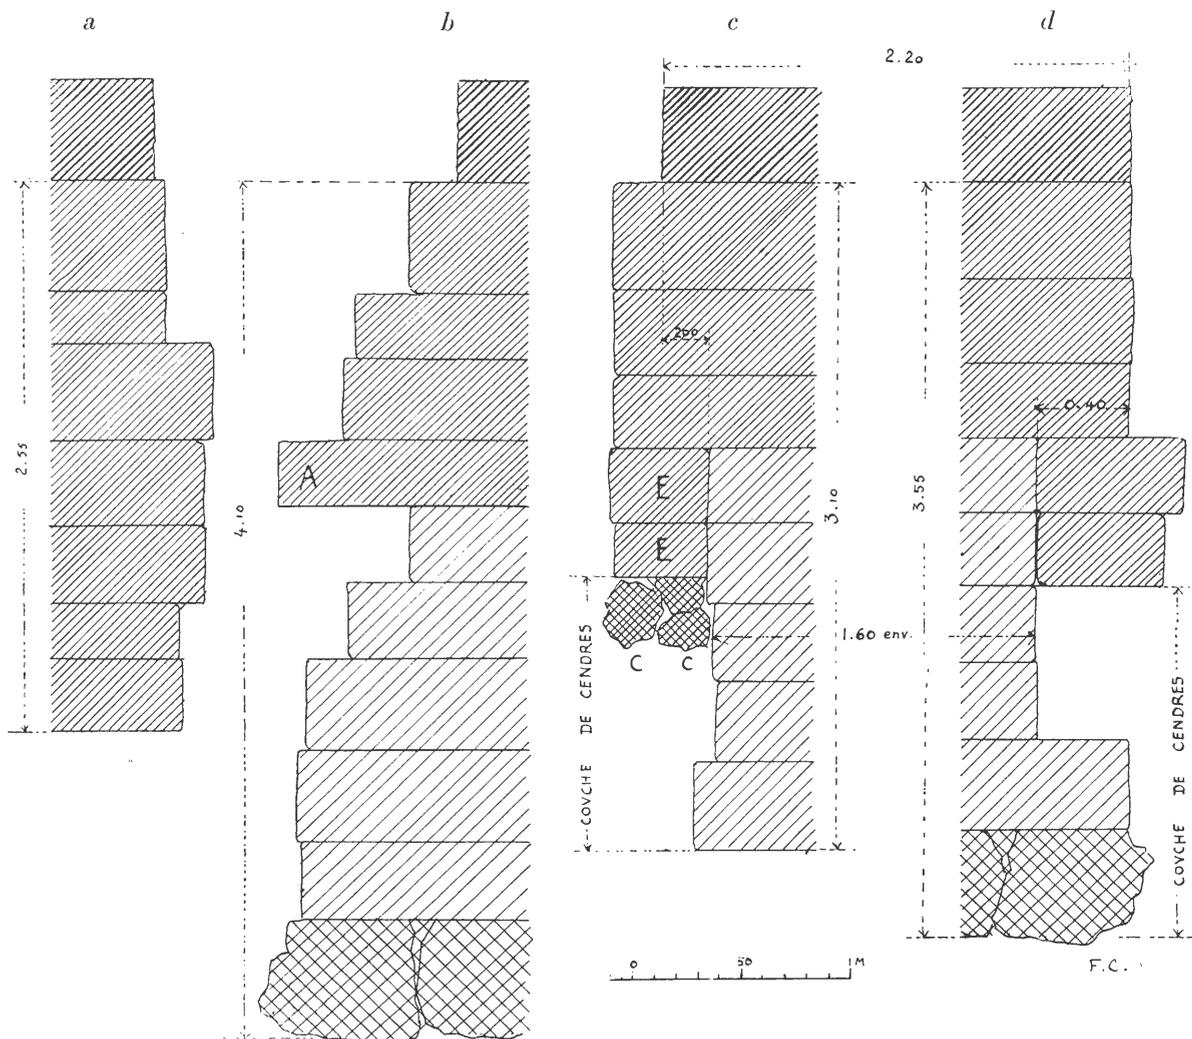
Coupes sur les fondations du rectangle intérieur (état actuel).
